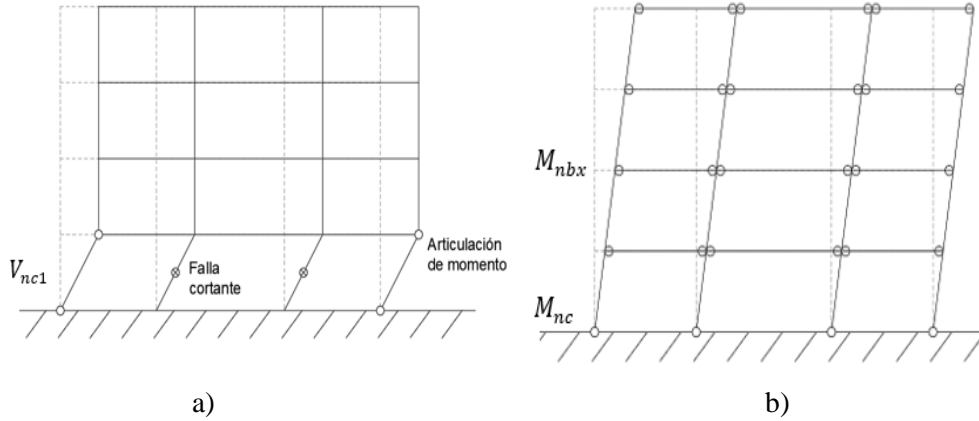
a) Mecanismo de falla 1, b) Mecanismo de falla 2, ambos para marcos de concreto reforzado (adaptado del FEMA, 2018)
